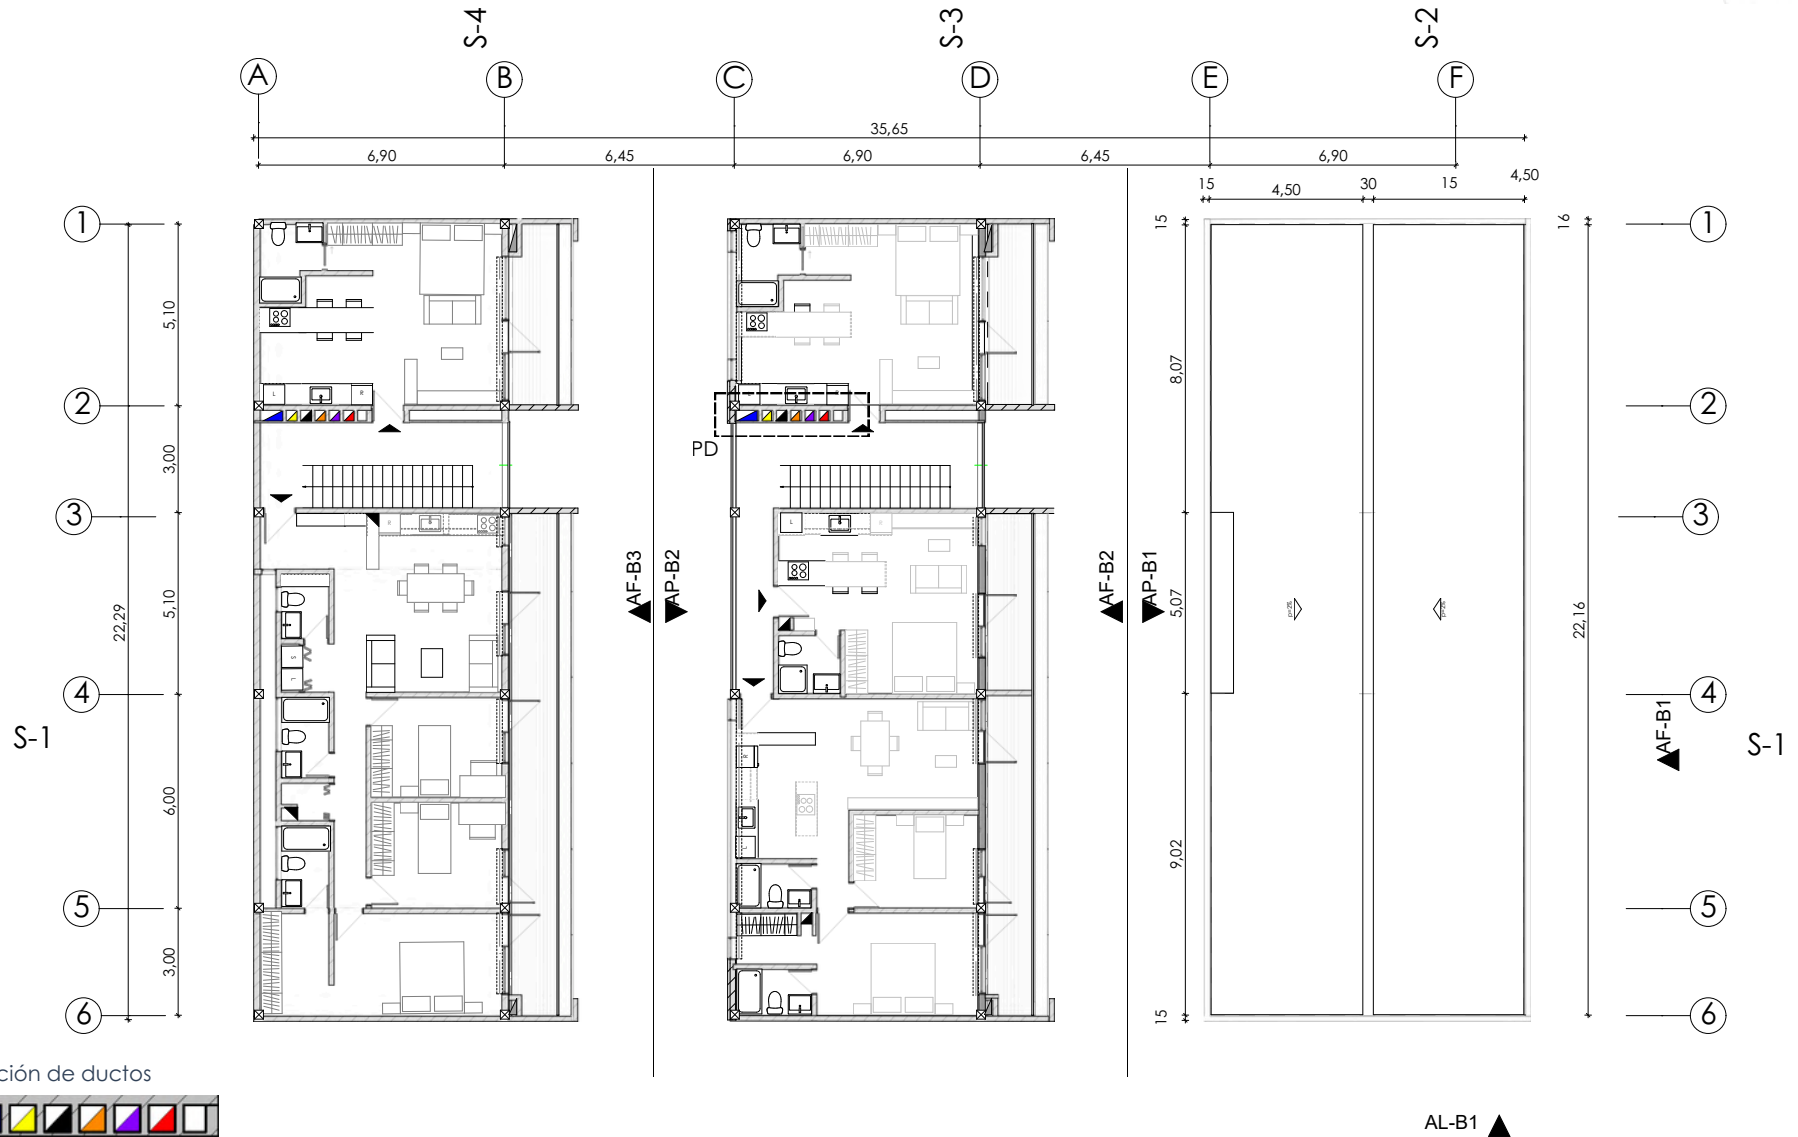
(tercera planta alta) 2026, Autoría propia.
